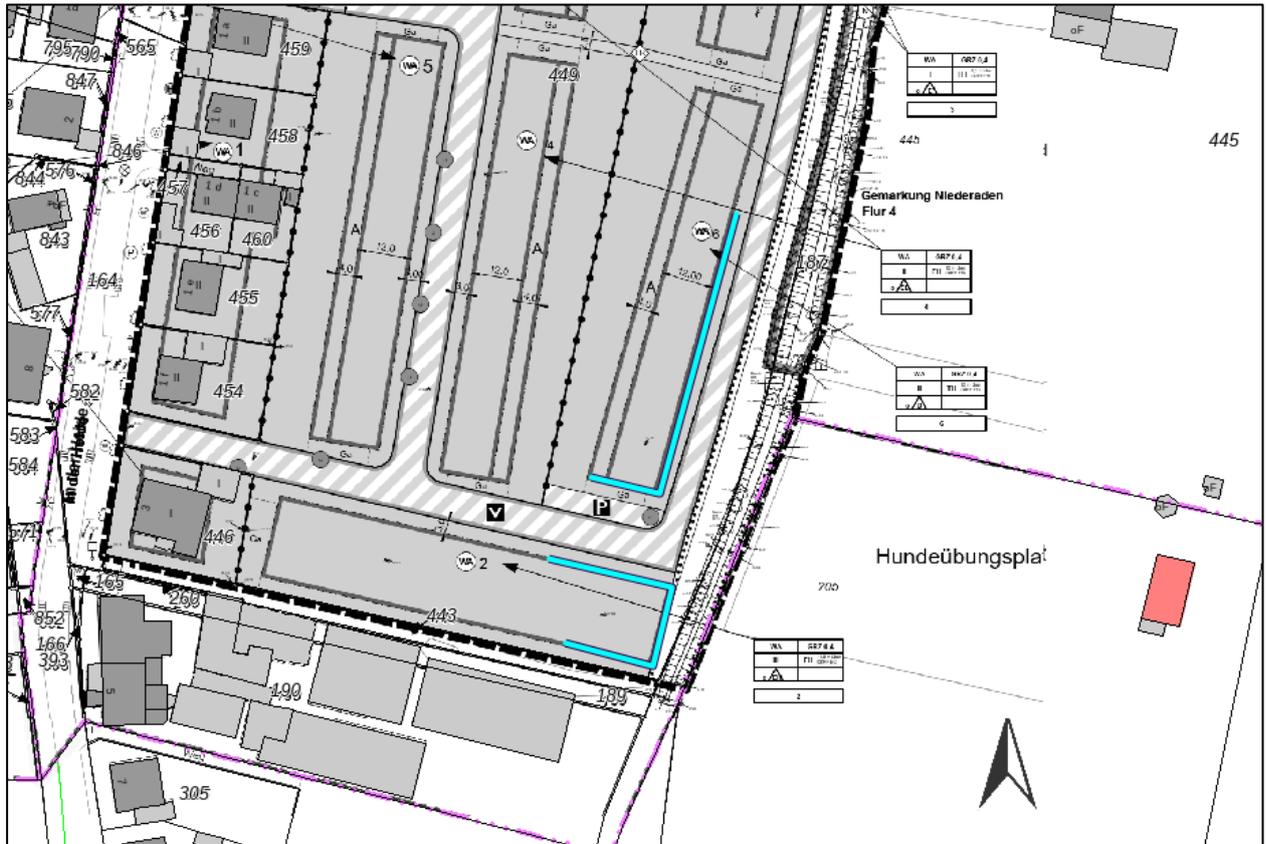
Darstellung Markierung (türkis) Fassaden ohne Zulässigkeit von Immissionsorten, Quelle Bebauungsplanentwurf Stadt Lünen
